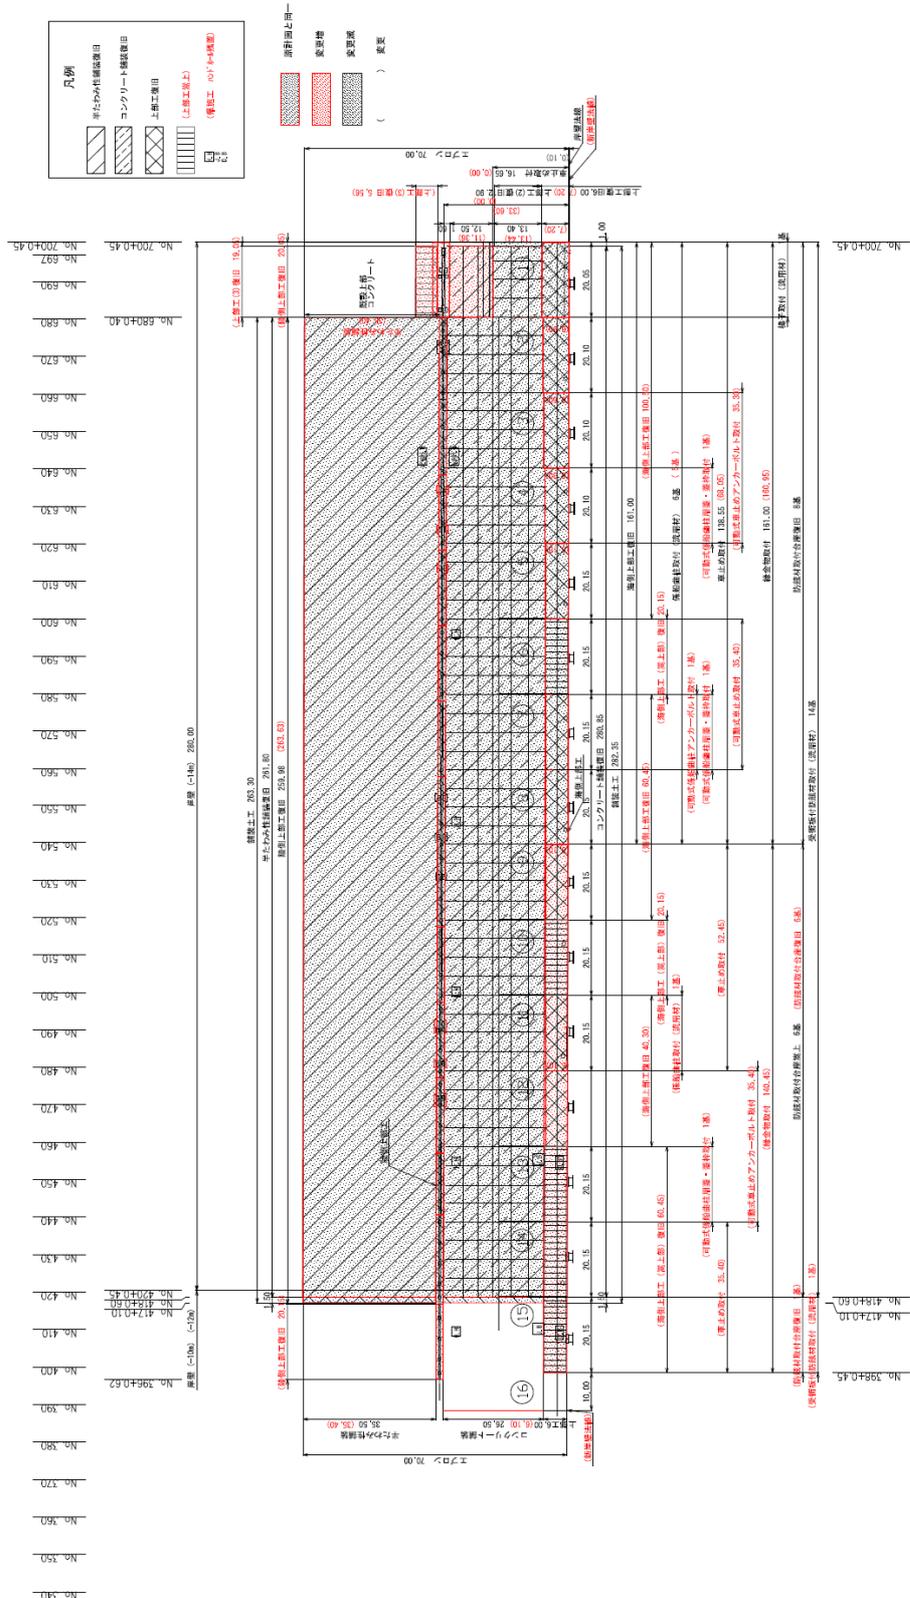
95 No.6 常陸那珂港区_北ふ頭岸壁(-14m)の平面図 (復旧後)
